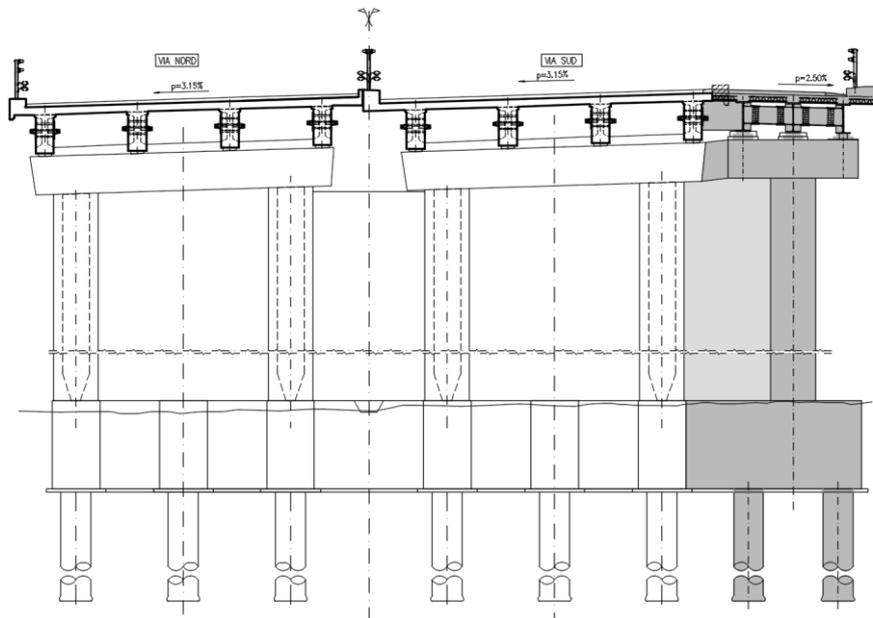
Sezione trasversale di progetto delle pile del viadotto Zuane
